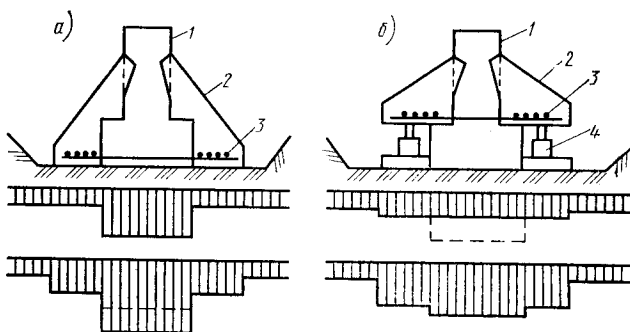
Варианты уширения подошвы фундамента и эпюры давлений (по Б. И. Далматову):
